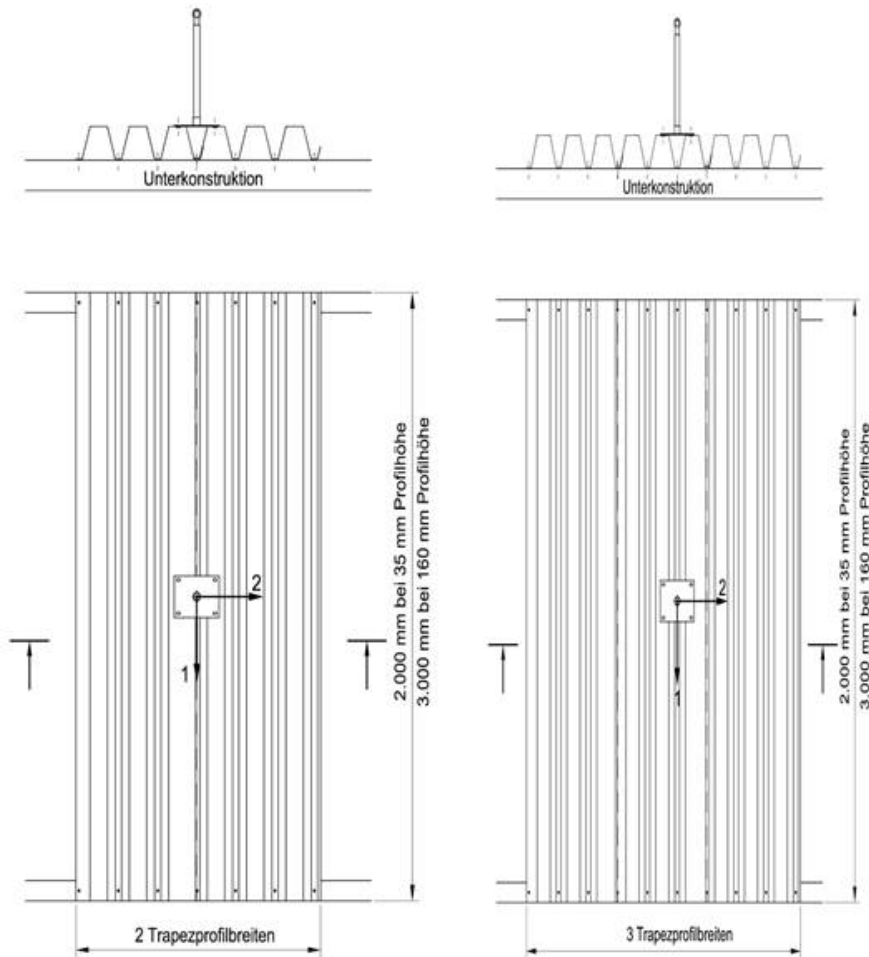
Anwendungsbereich auf Stahltrapezprofil (Positivlage)
